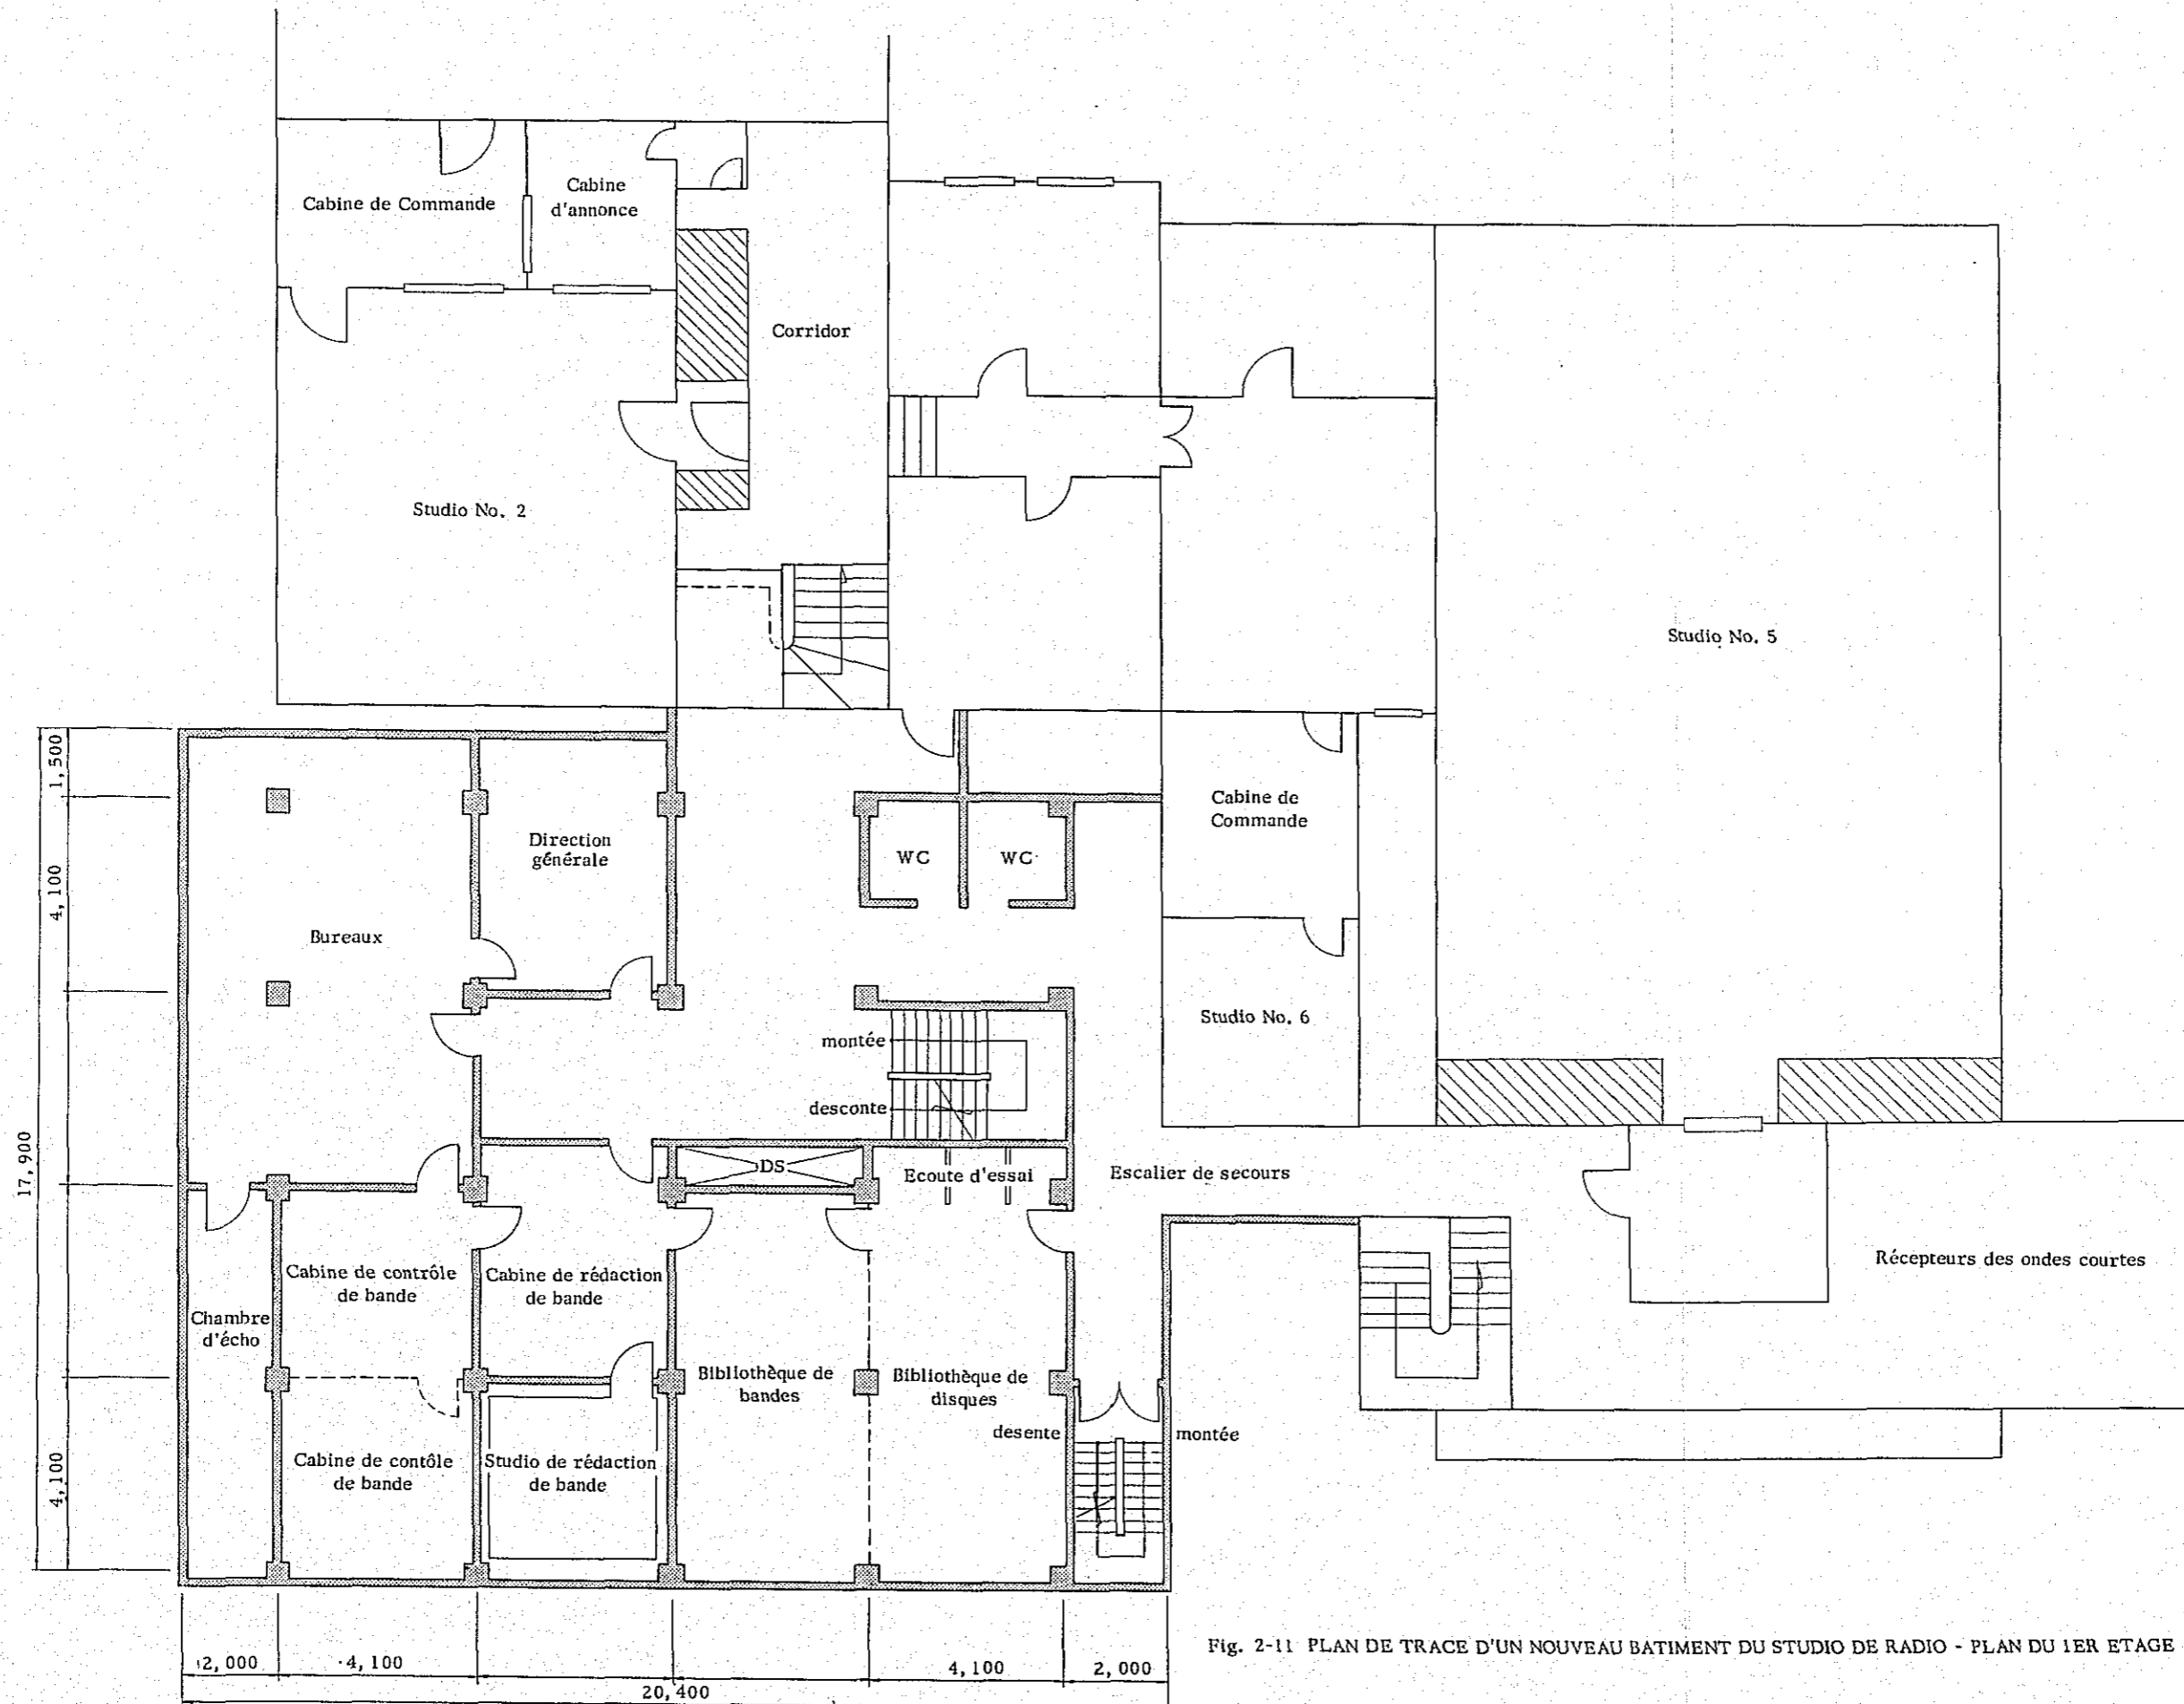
PLAN DE TRACÉ D'UN NOUVEAU BATIMENT DU STUDIO DE RADIO - PLAN DU 1ER ETAGE
